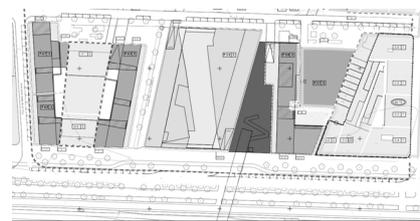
Plano de Pormenor do Aterro da Boavista Nascente
